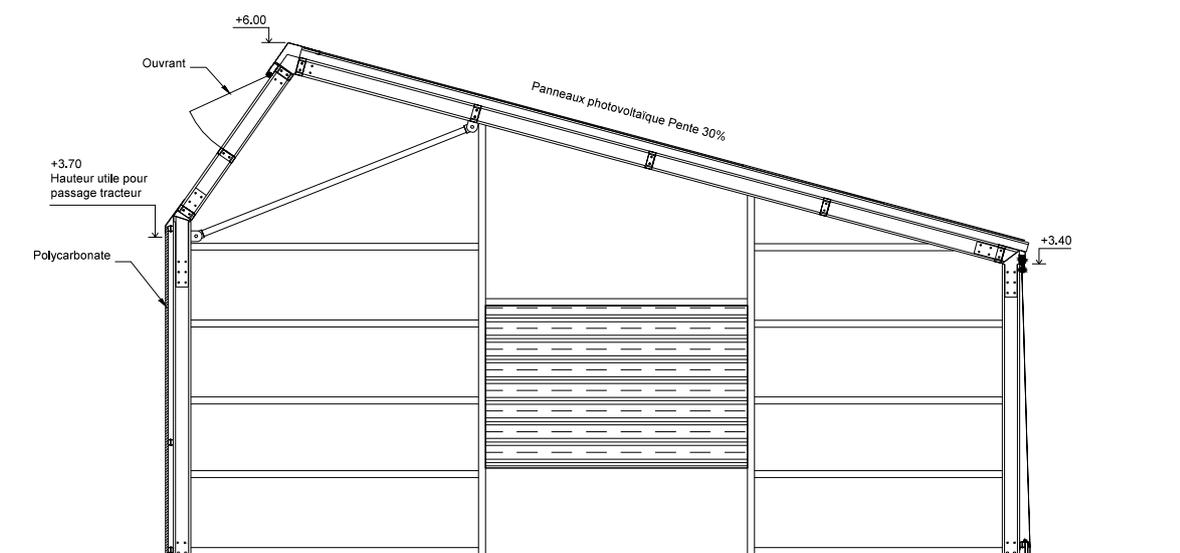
Plan de coupe : Toiture serres et système d'aération pan Nord
